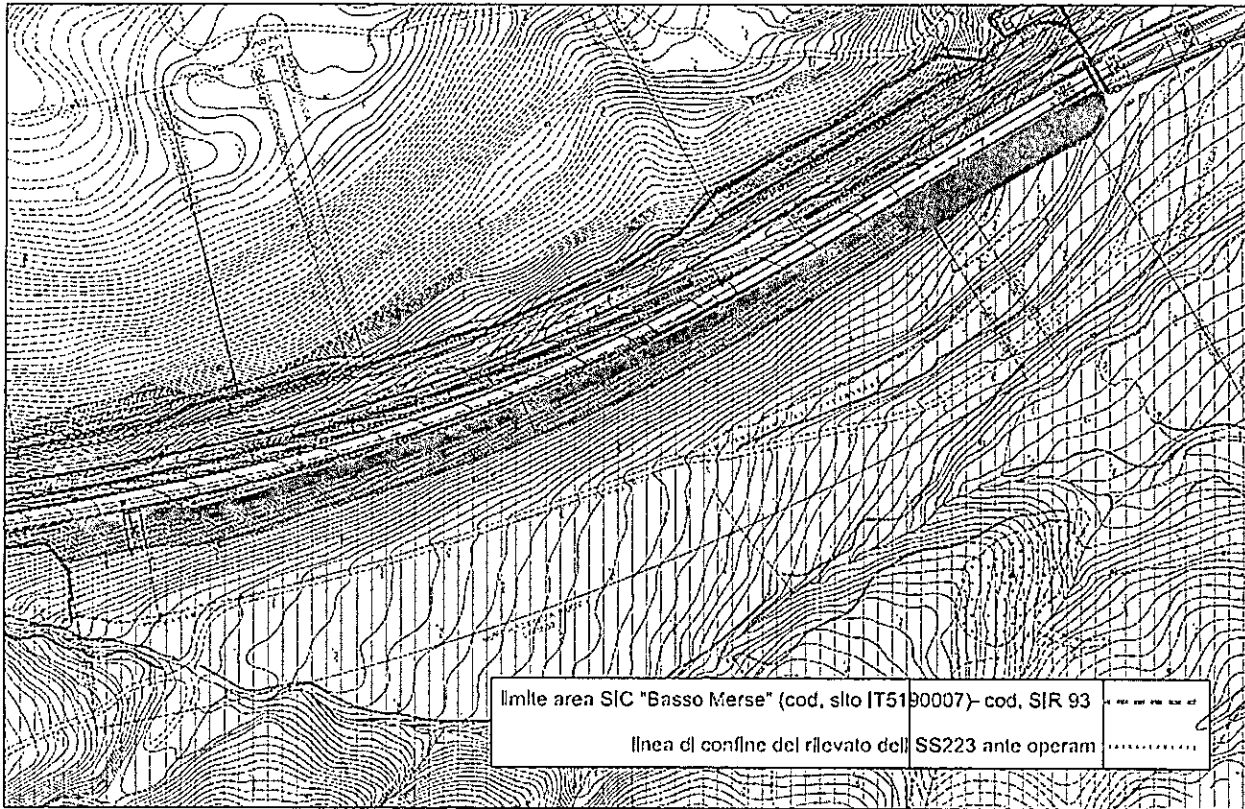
Stralcio planimetrico – Sistemazione carreggiata destra – Progetto Esecutivo MTR20
